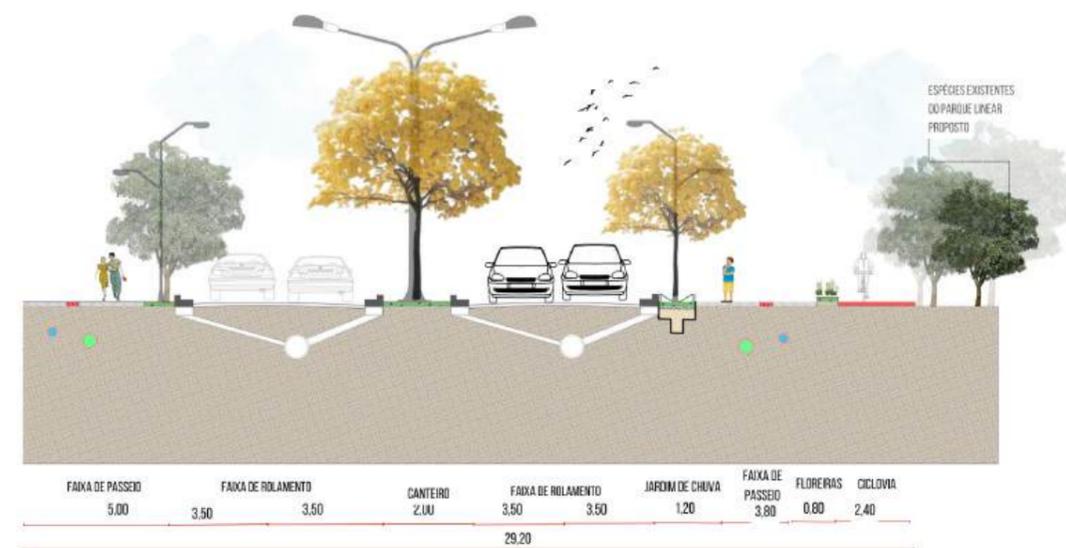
Planta baixa da proposta do trecho da Rua Betoia
